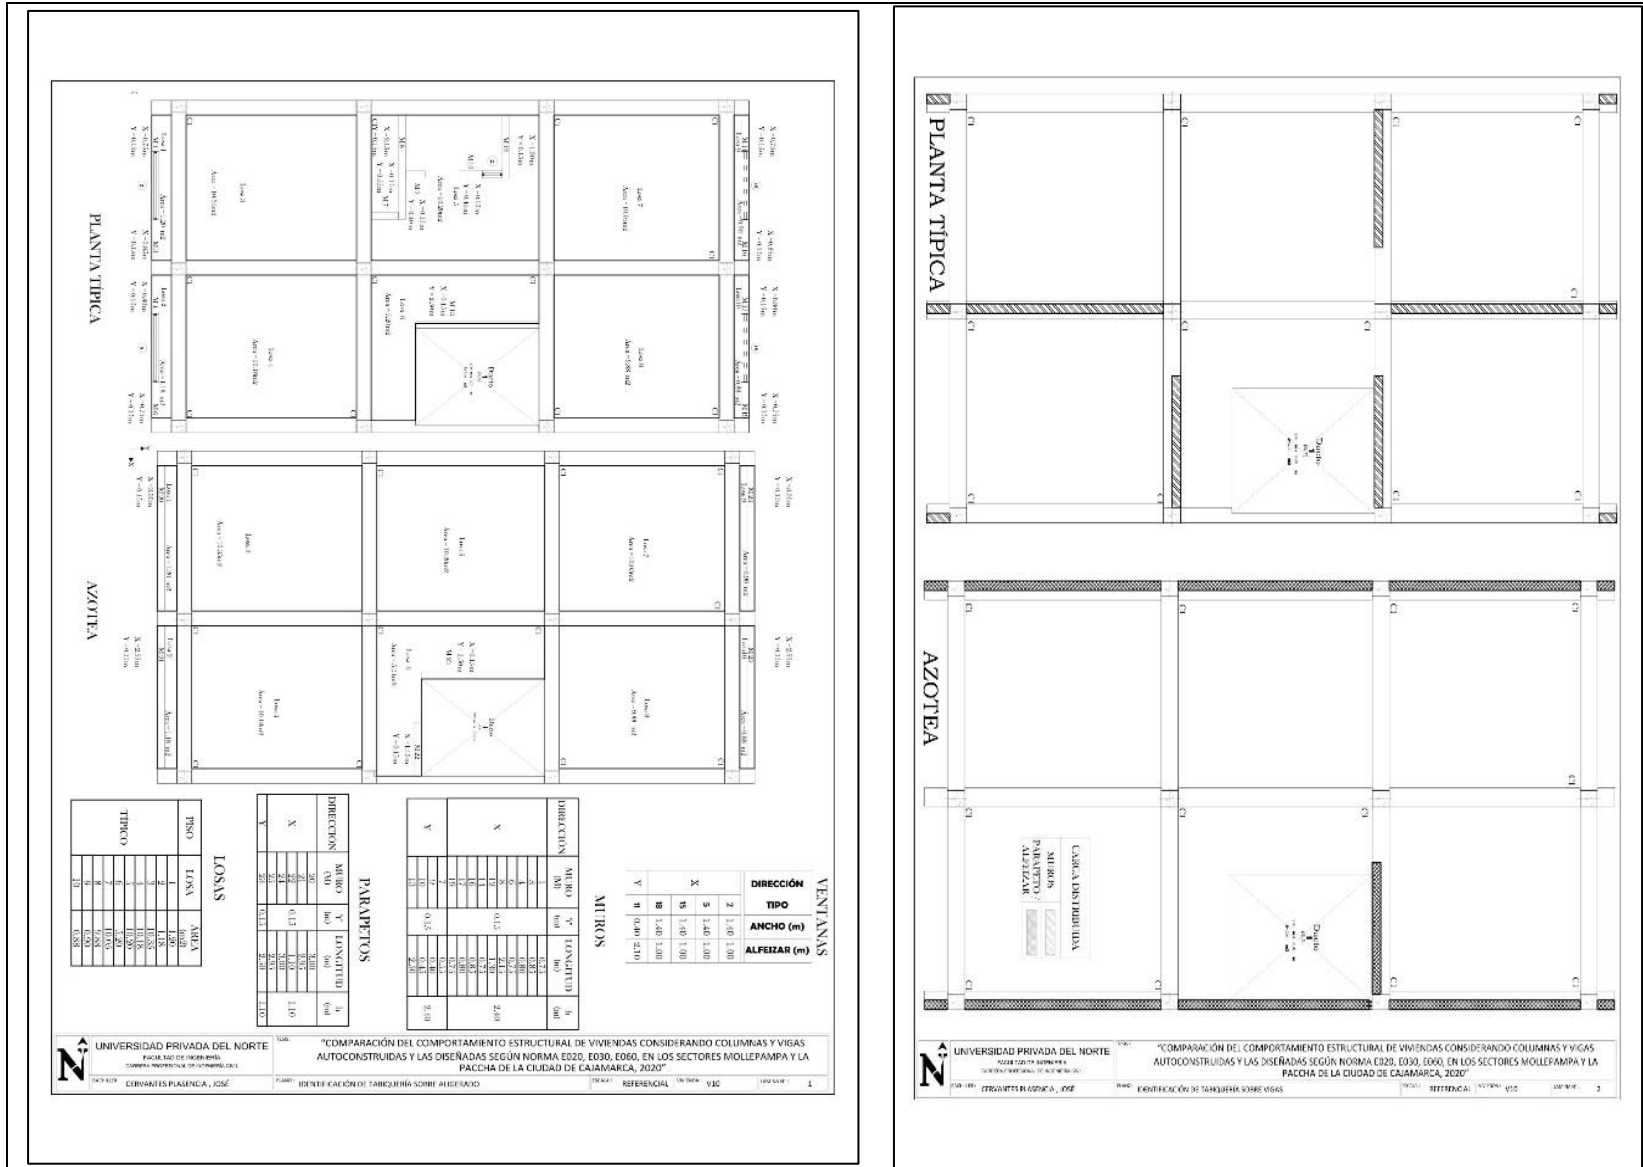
Tabiquería sobre losa aligerada y vigas vivienda 10
